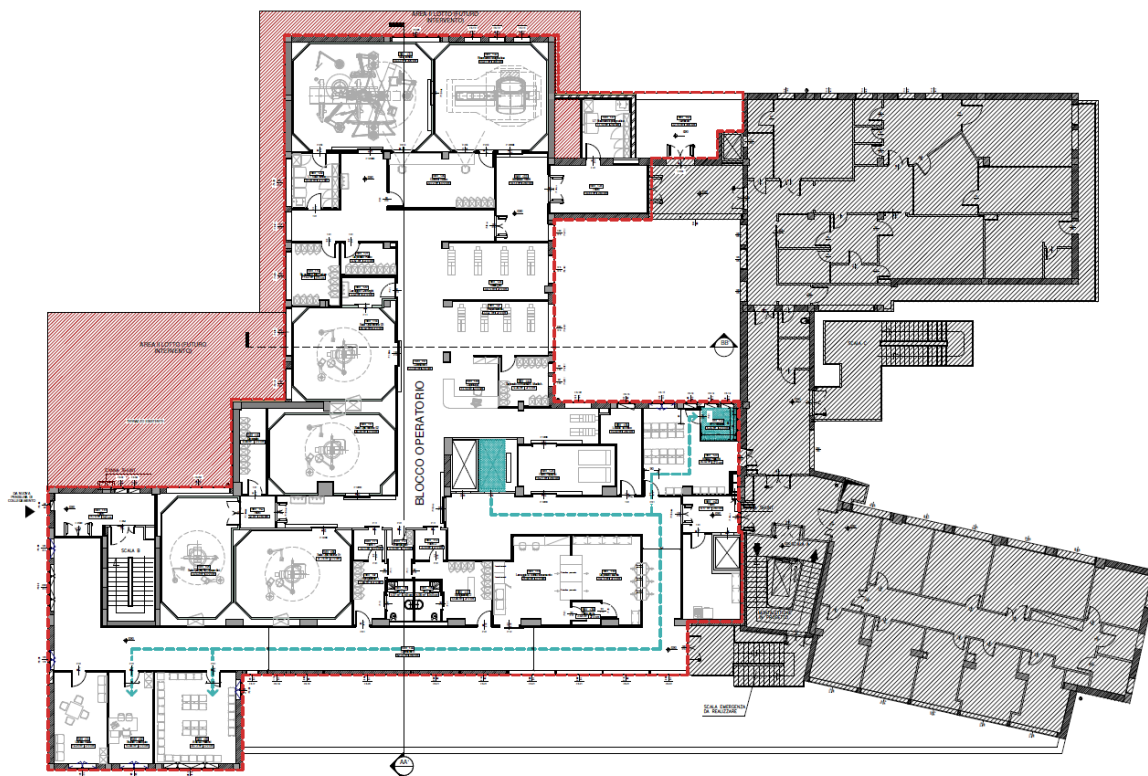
Pianta livello +1 – Abbattimento barriere architettoniche
